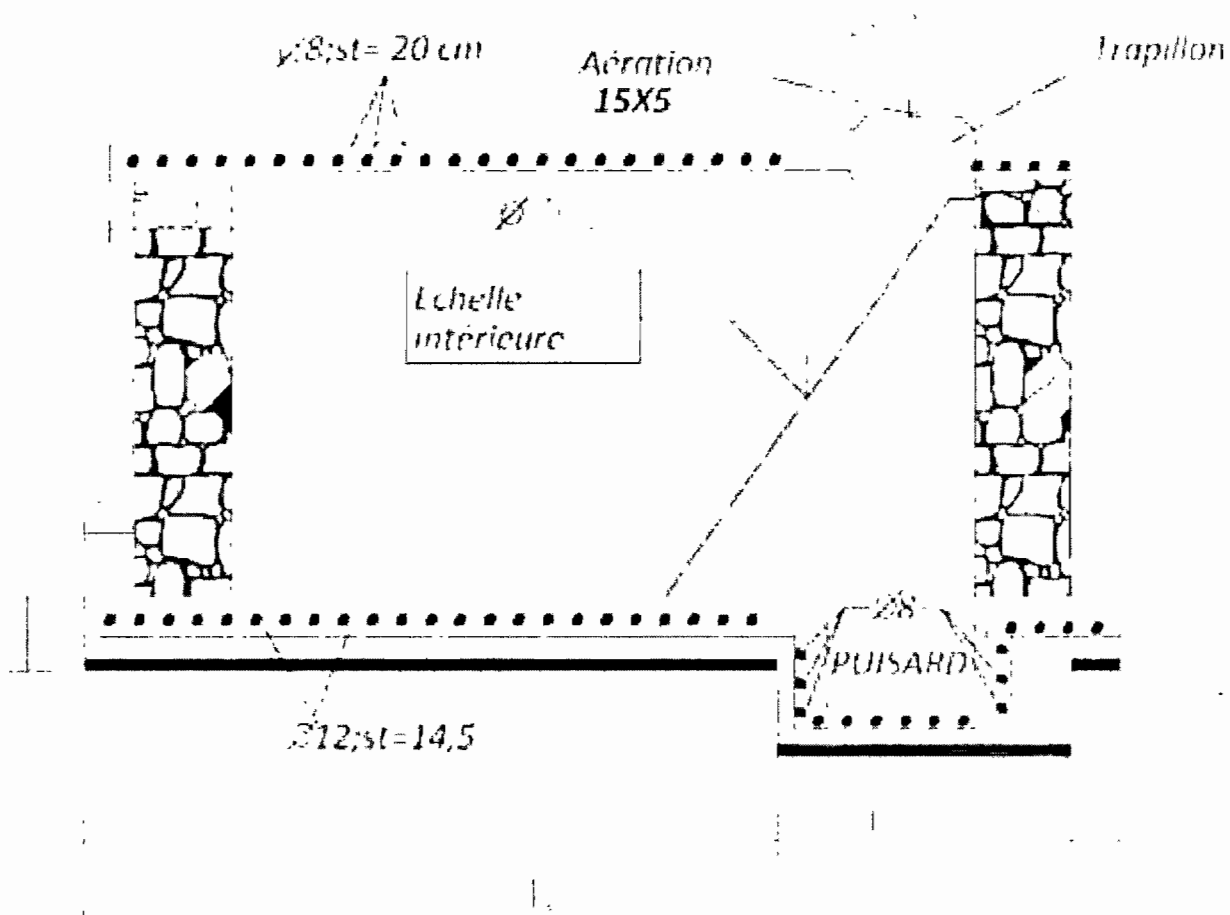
coupe longitudinale d'un réservoir de 10m³
